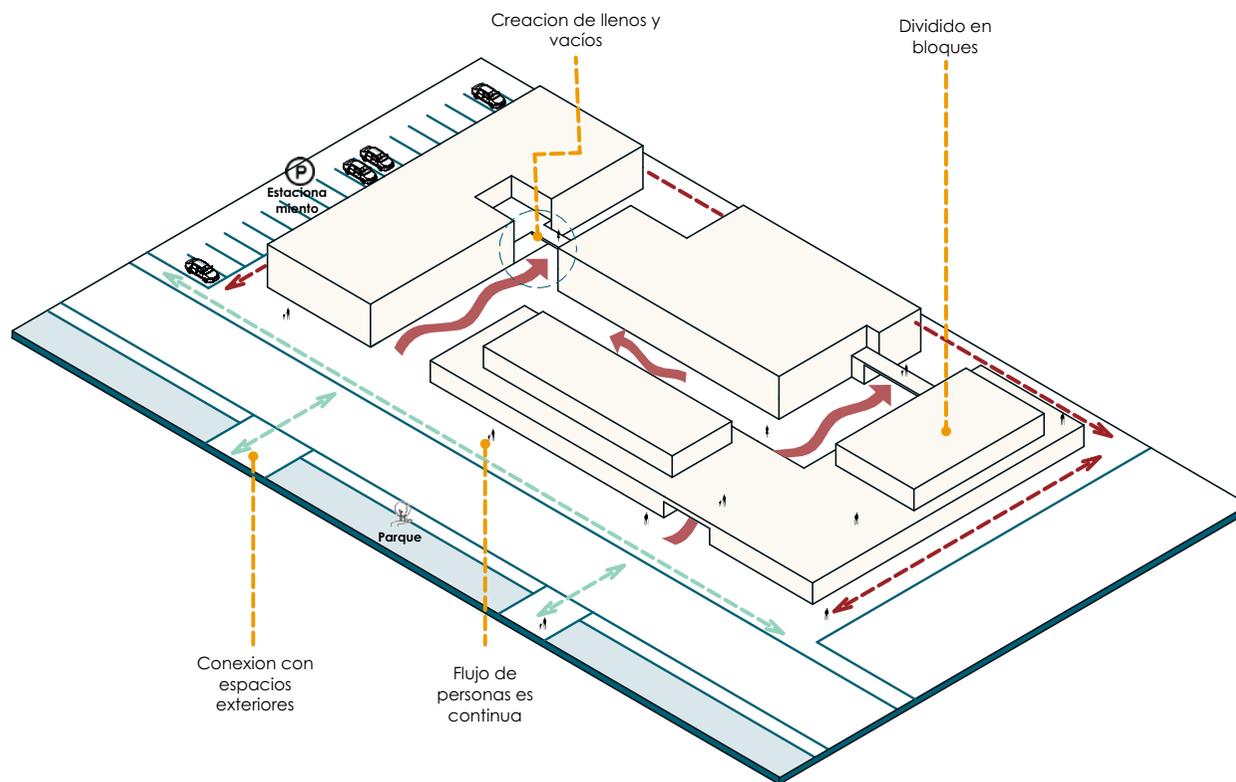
Planta baja. Conexión dentro y fuera del mercado.
